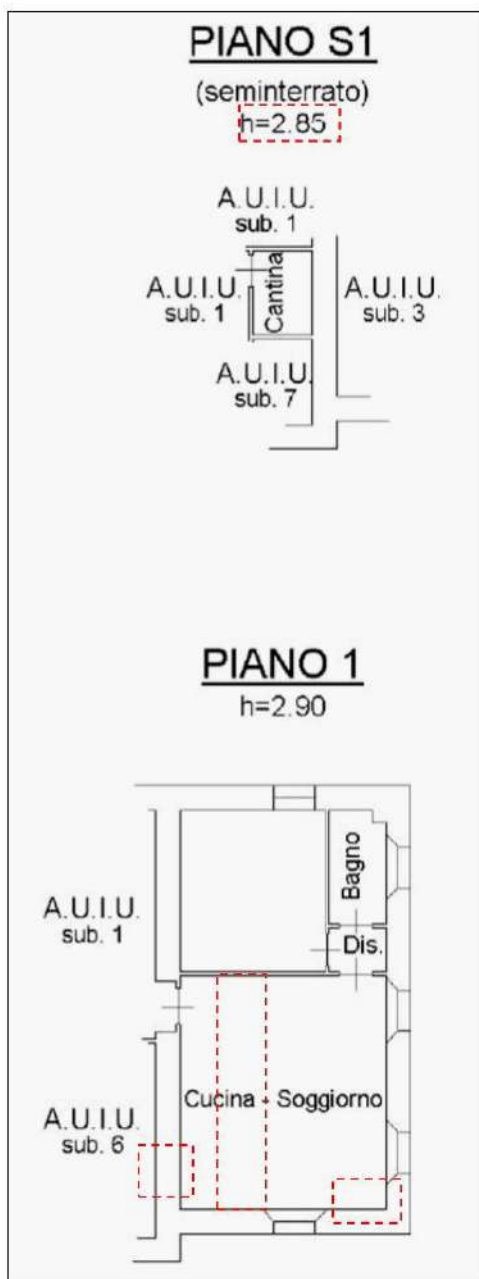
Planimetria castale appartamento con cantina (Sub. 5)
